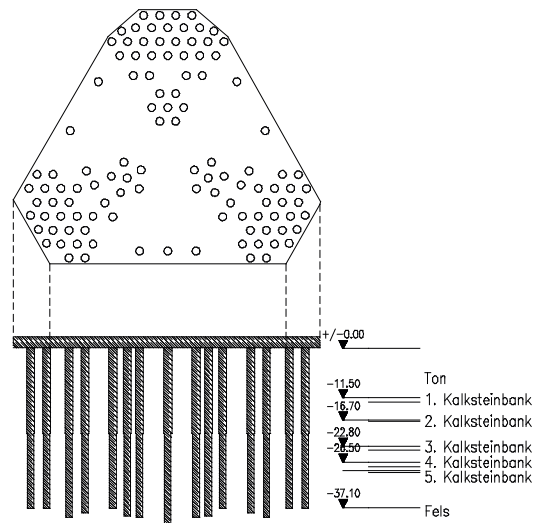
Grundriss und Schnitt der Pfahl-Plattengründung Commerzbank-Hochhaus Frankfurt am Main
